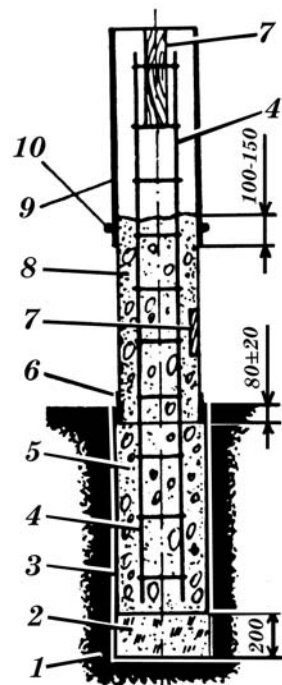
Конструктивная схема столбчатого набивного фундамента на глубину промерзания грунта: 1 – грунт; 2 – песок; 3 – труба-опалубка (первая); 4 – арматура; 5 – бетонная смесь; 6 – остаток трубы-опалубки (второй); 7 – деревянный вкладыш; 8 – бетонная смесь (застывшая); 9 – труба-опалубка (третья) для заполнения смесью; 10 – проволока.
